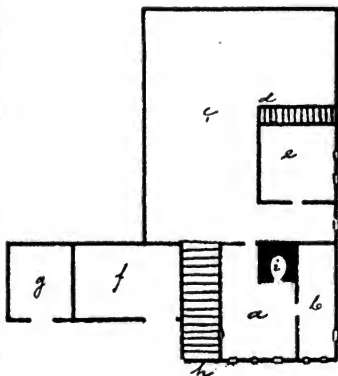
Grundriss des vorigen Hauses.
